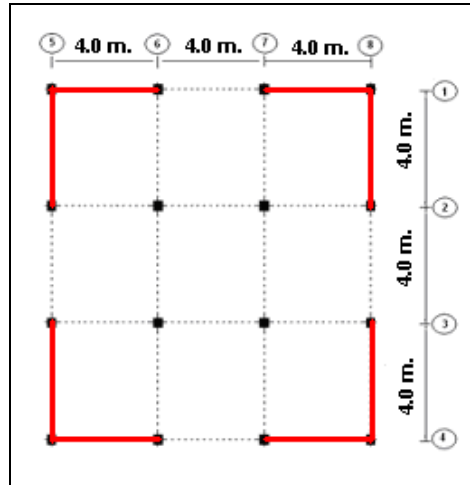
Planta tipo de las estructuras de 3, 6 y 9 pisos.
